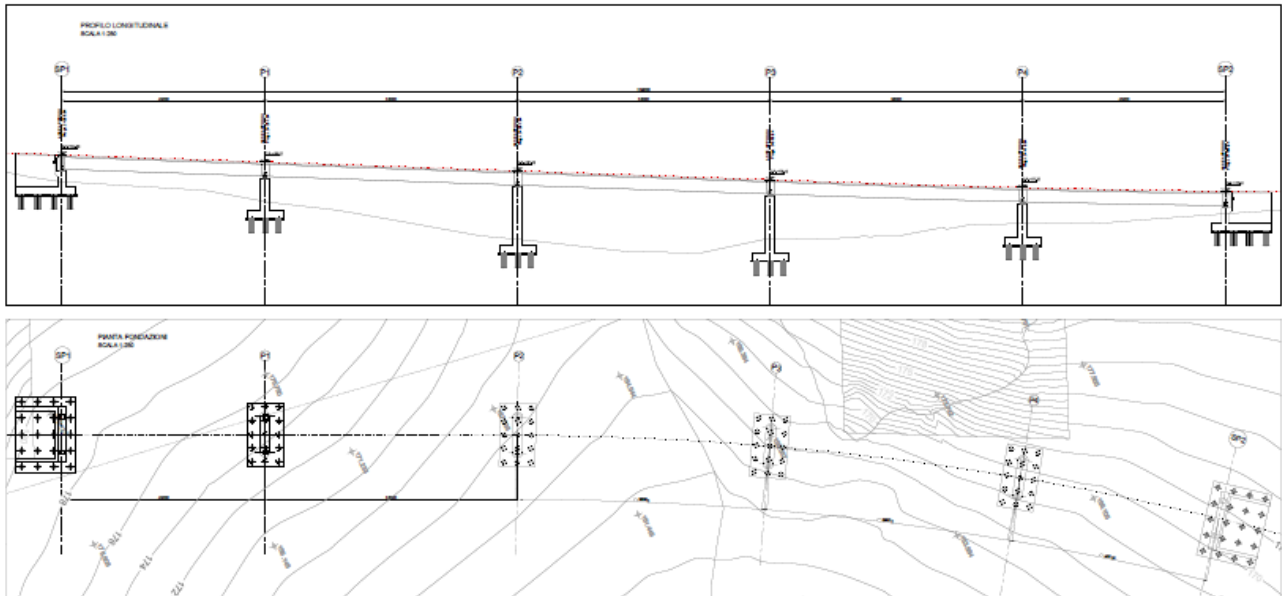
Profilo e pianta delle fondazioni del Viadotto Pieve
